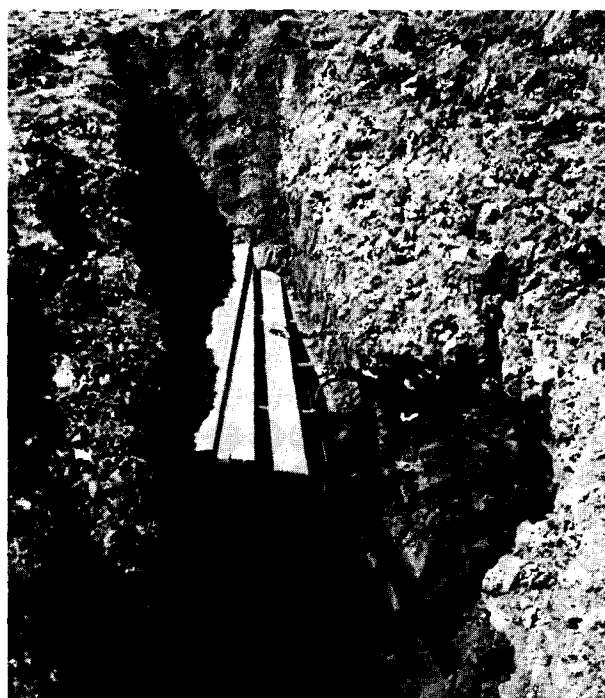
Tranchée drainante : blindage glissant provisoire.
